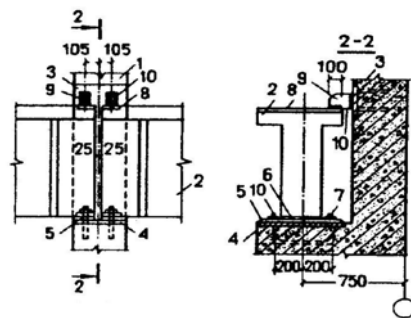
Кріплення збірних залізобетонних підкранових балок до колон каркаса:
